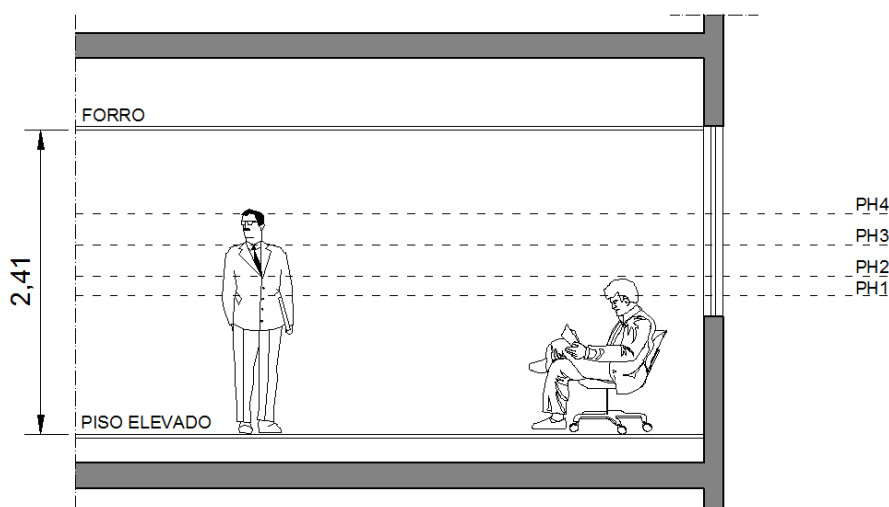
Indicação dos planos horizontais em corte.
